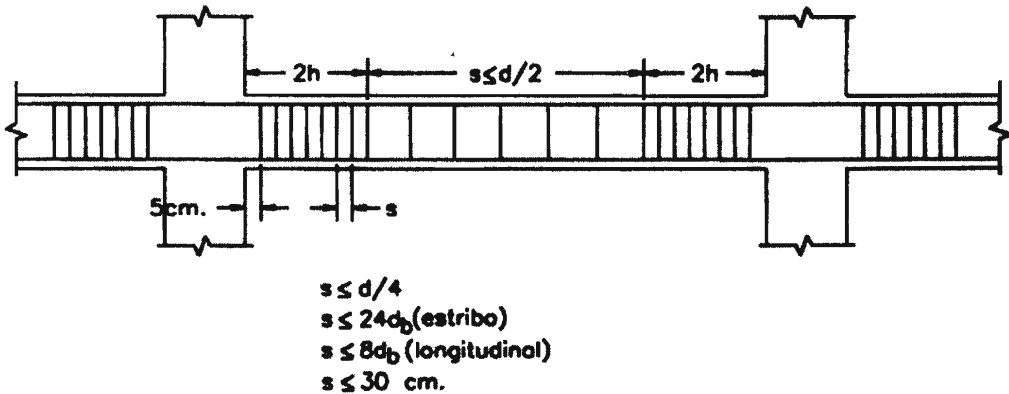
Distribución del refuerzo transversal mínimo en elementos sometidos a flexión
